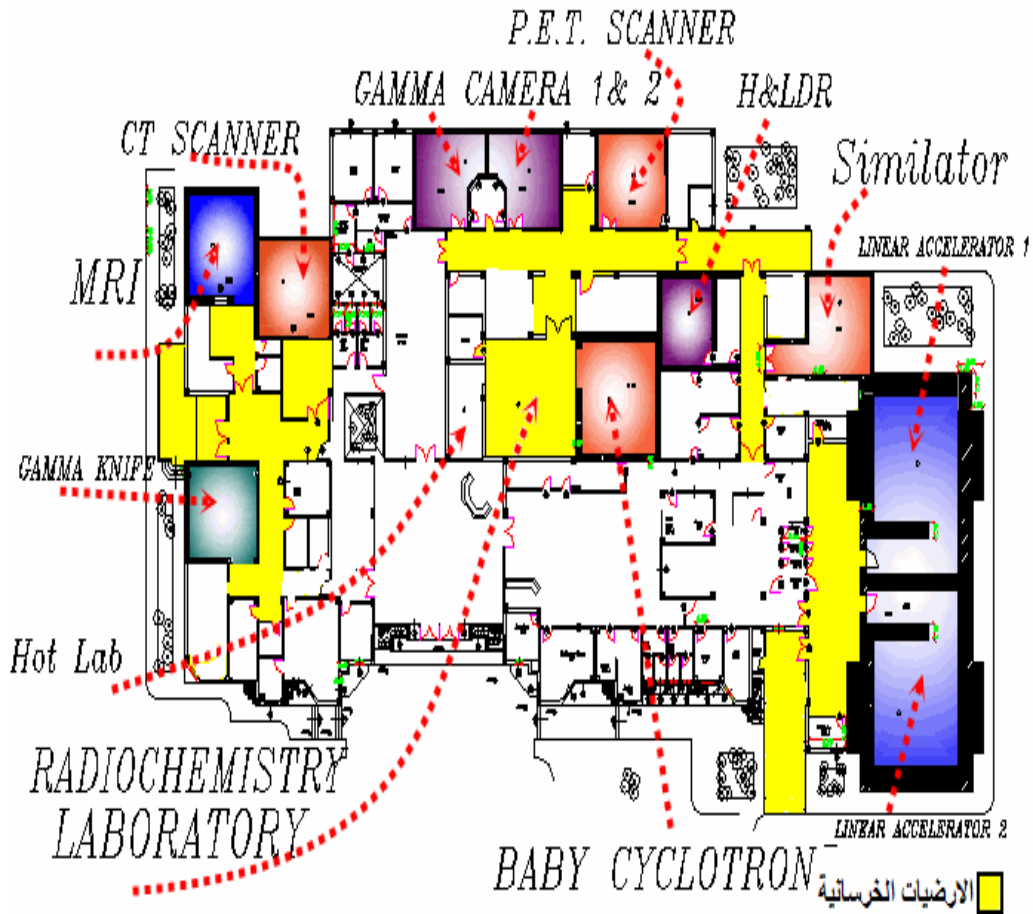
مسقط افقى لحجرة المعجل الخطى
